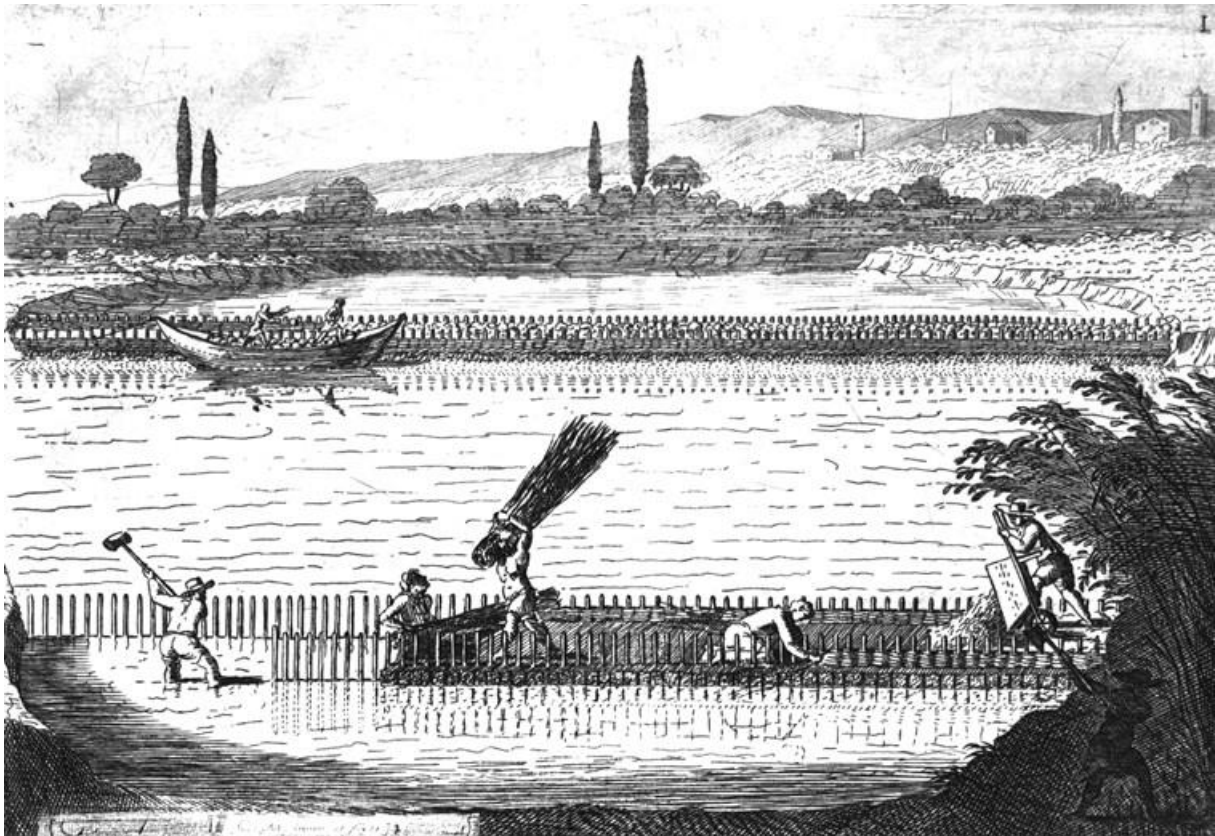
Cornelius Meyer 1685, construction d'ouvrages à base de fascines et tressage pour la navigation. Un ouvrier coupe les saules à droite, un second plante les pieux à gauche, deux mettent en place les fascines, un autre tresse (clayonnage) pour bloquer les fascines et un dernier les couvre de gravier, alors que l'on peut observer une berge érodée au fond.
